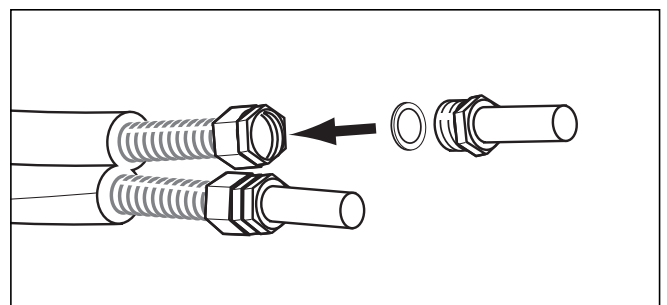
Poser la bague d'étanchéité et monter le raccord G 3/4" sur la vis de serrage 18 mm.
